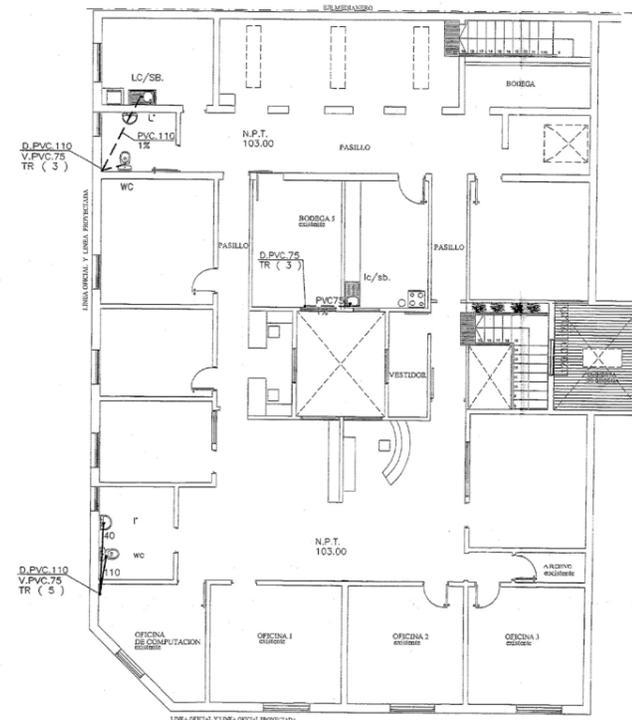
Plano de alcantarillado de 1923 del caso 9.
